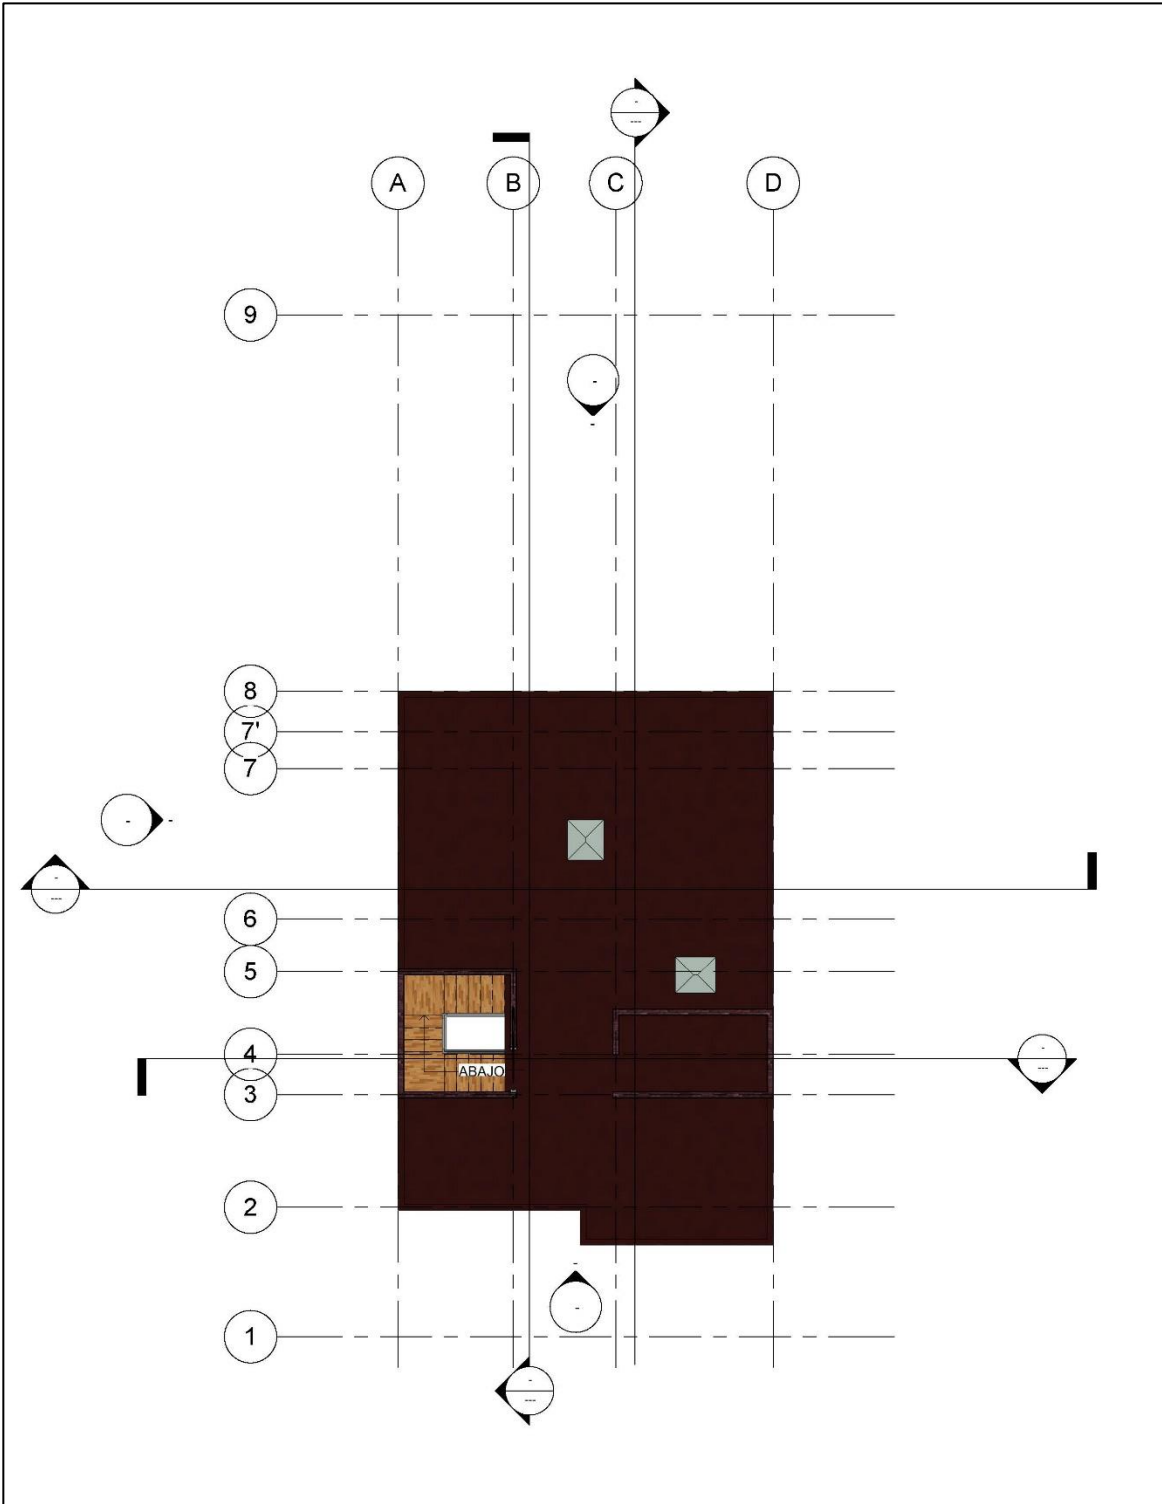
Plano de vivienda no sustentable: planta azotea. Fuente: autoría propia
